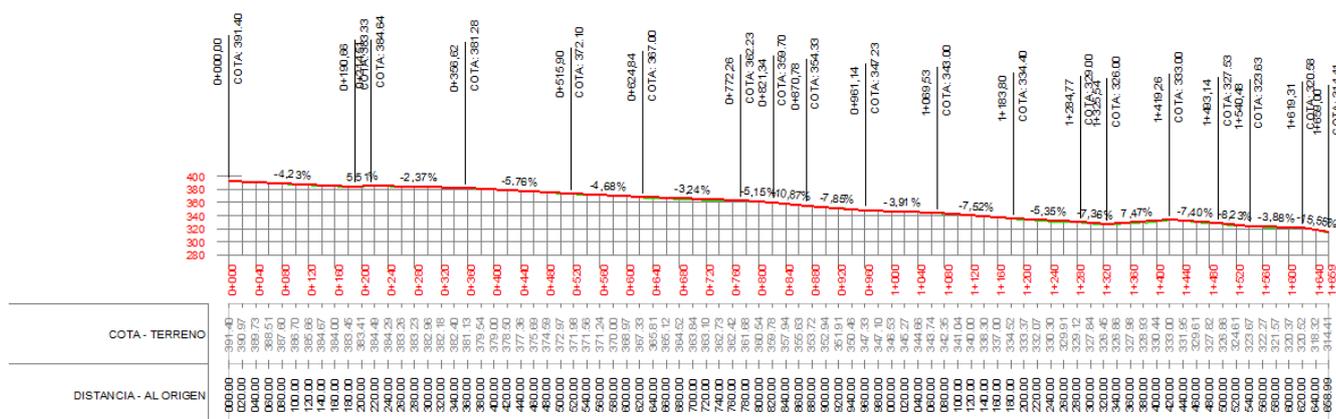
Perfil longitudinal Acceso sur monte Salmerón
